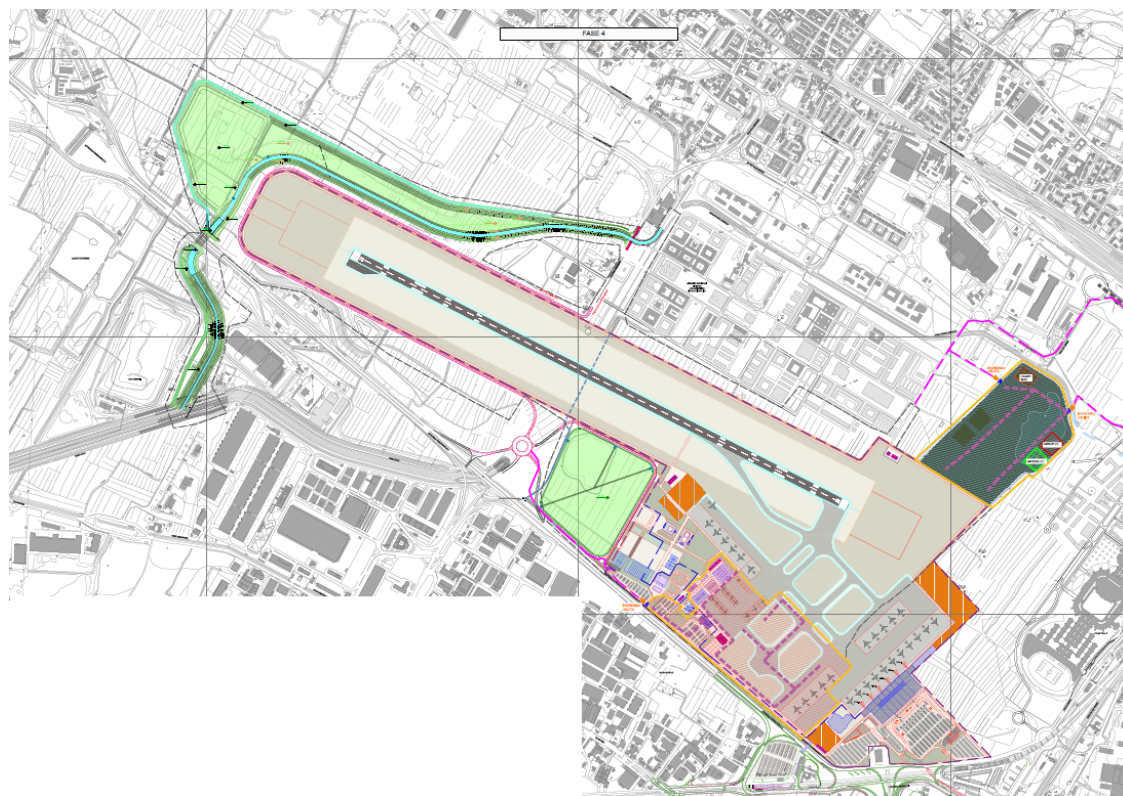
Cantierizzazione dell'Area Nuova Pista – Fase 4
